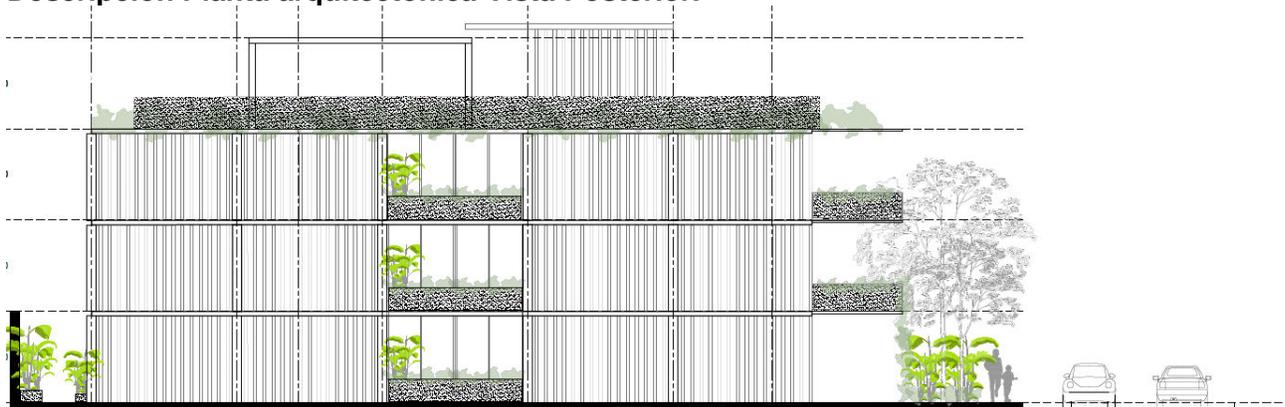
Plano Fachada Posterior. Fuente: Plano Arquitectónico.
